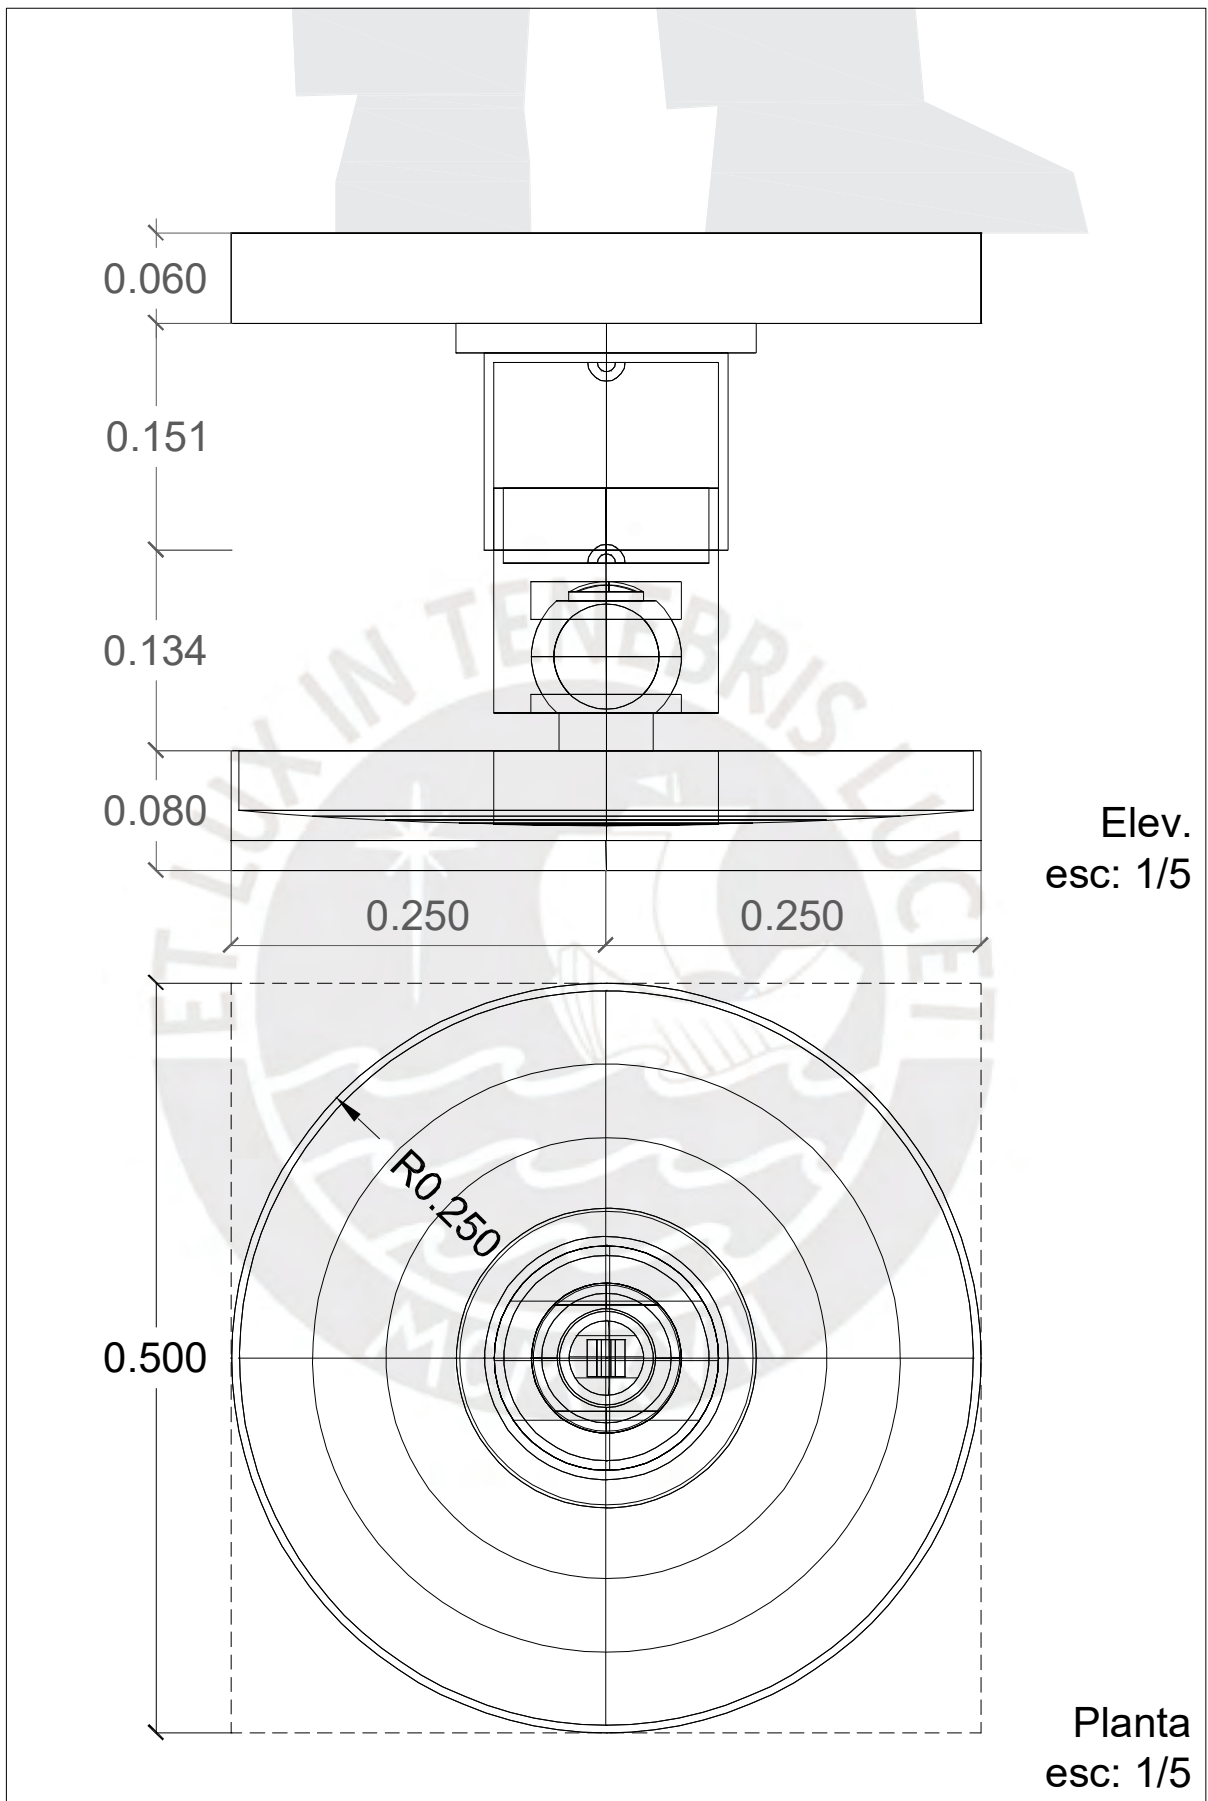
18: Elevación y planta del tercer modelo de sistema de aislamiento.
